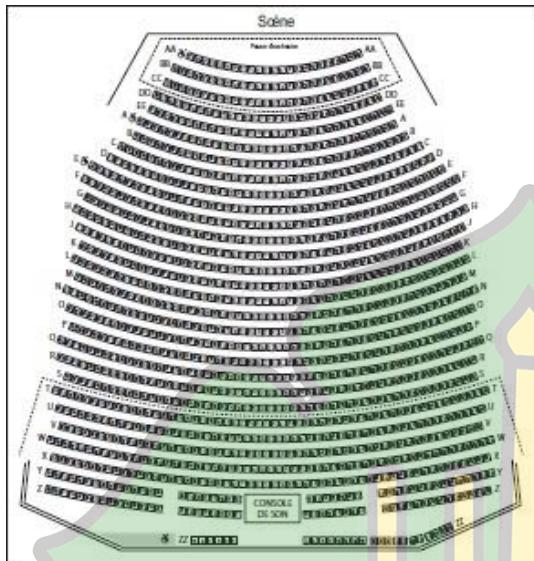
Gambar Denah Salle Wilfrid-Pelletier
